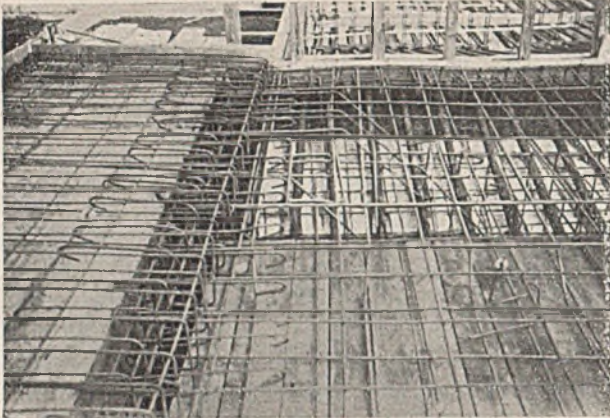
Fertig verlegte Bewehrung der Platte einer Randrippe.
